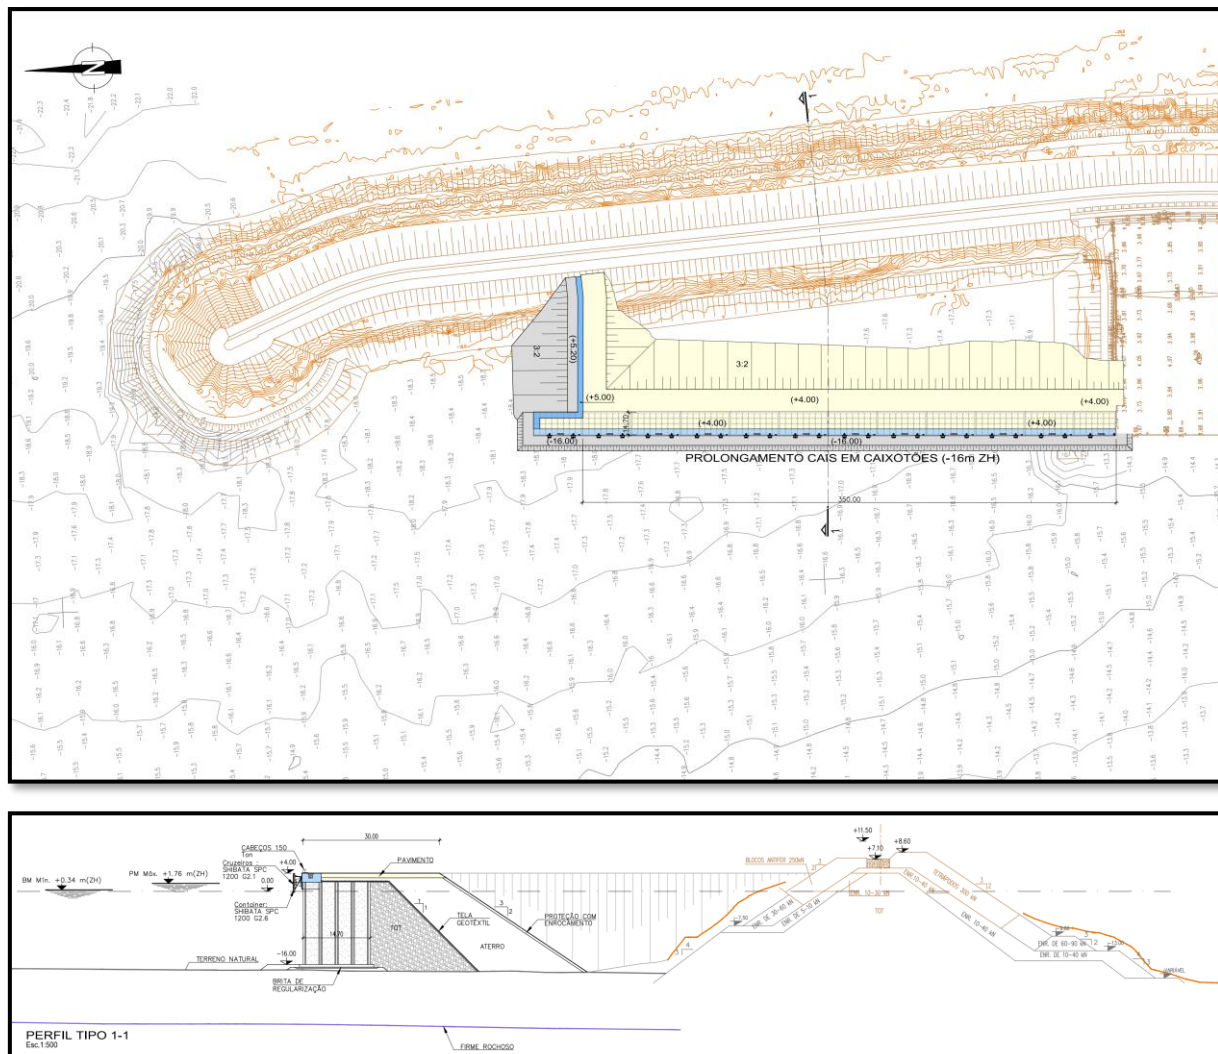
Prolongamento do cais existente à -12m(ZH) – SOLUÇÃO 3A (planta e perfil tipo)
